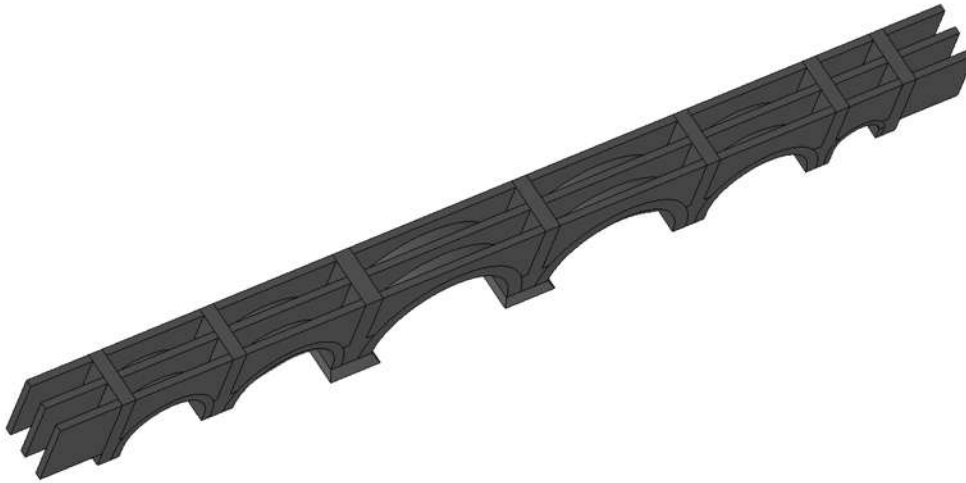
Muros tímpano y muro acostillado. Planta.
